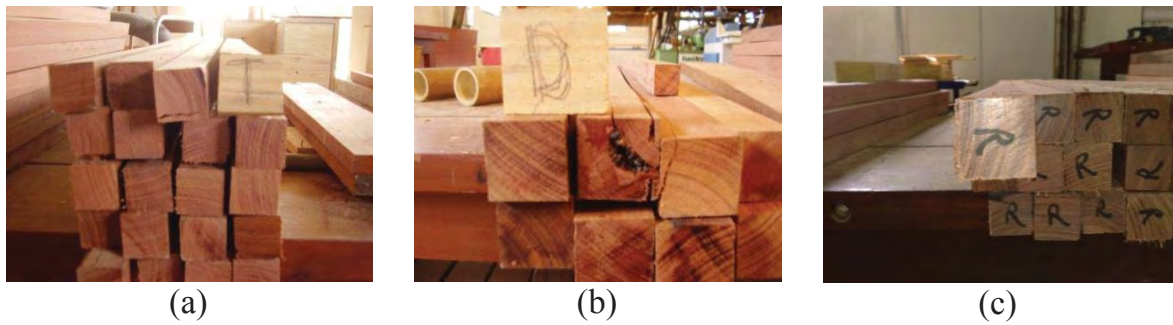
Classificação das peças segundo os planos de colagem: (a) plano tangencial “T”, (b) plano diagonal ‘R/T’ e (c) plano radial “R”.
